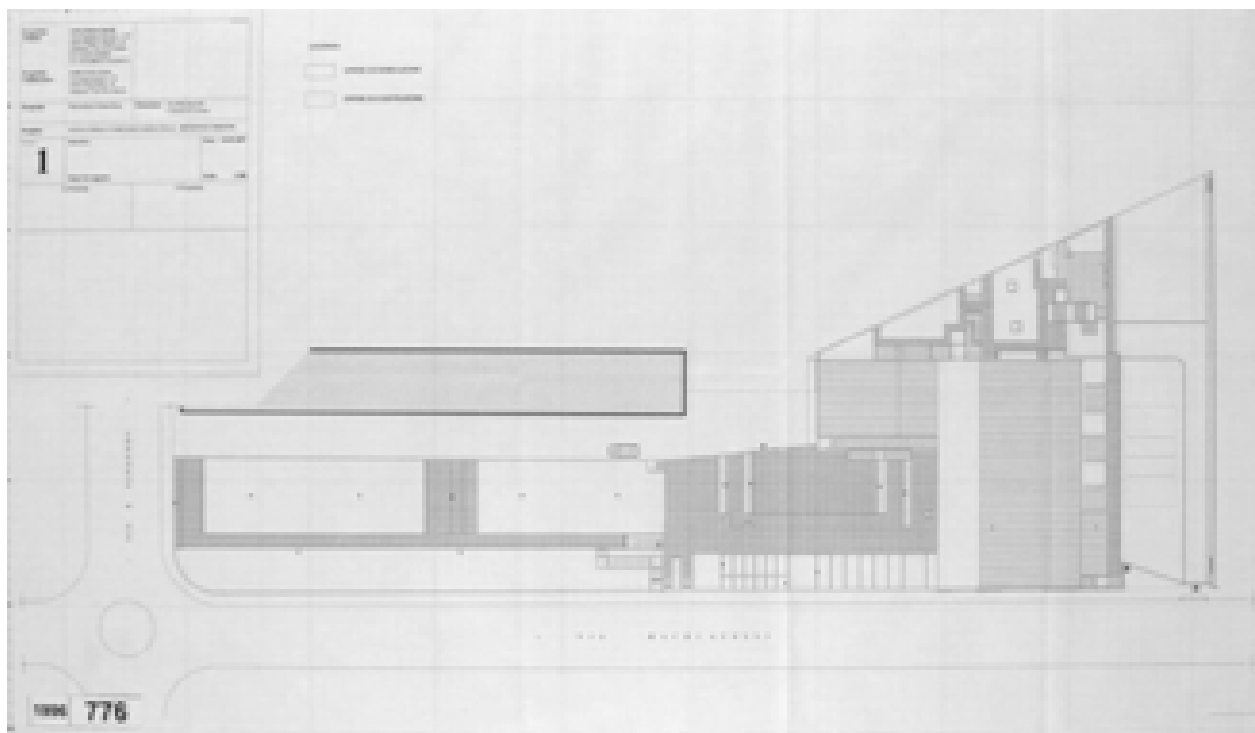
Planimetria generale, stato sovrapposto –10/09/2007 (AABS-1996.776)
